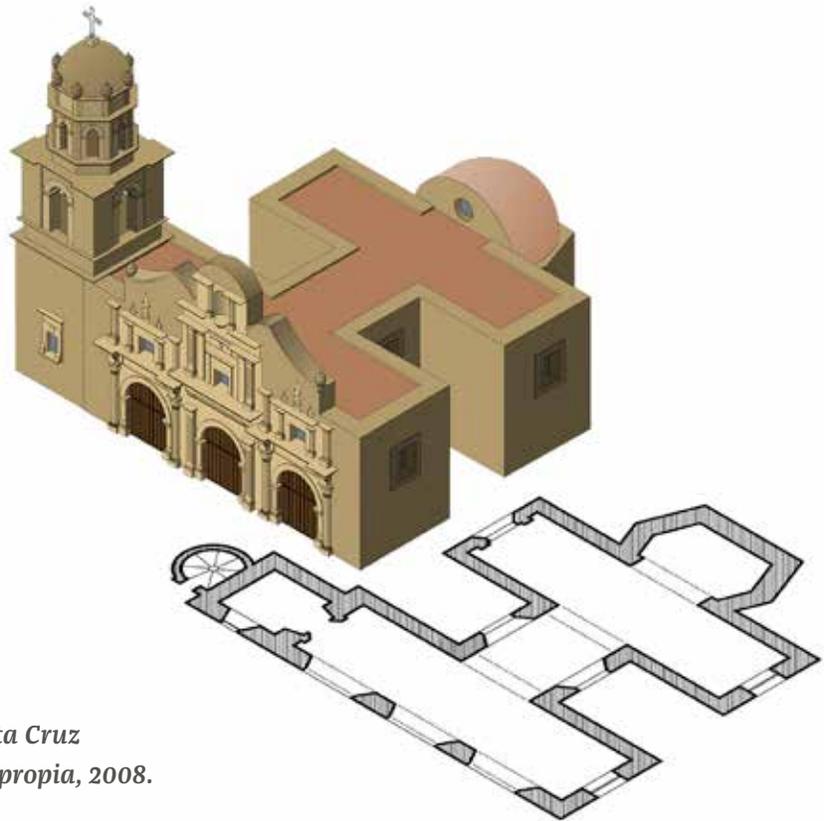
Dibujo y planta de Santa Cruz de las Flores. Fuente: Elaboración propia, 2008.
